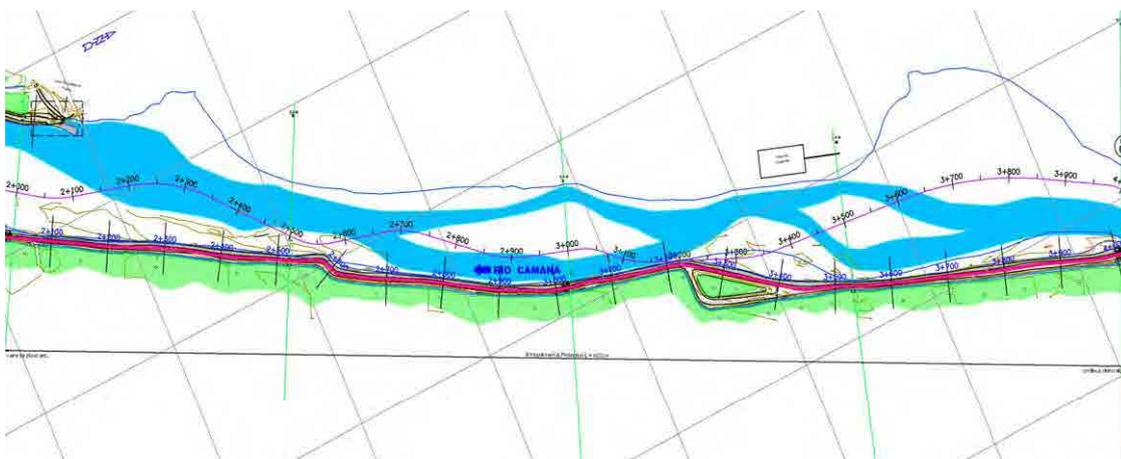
Planta de instalaciones Caman-1 (3)
